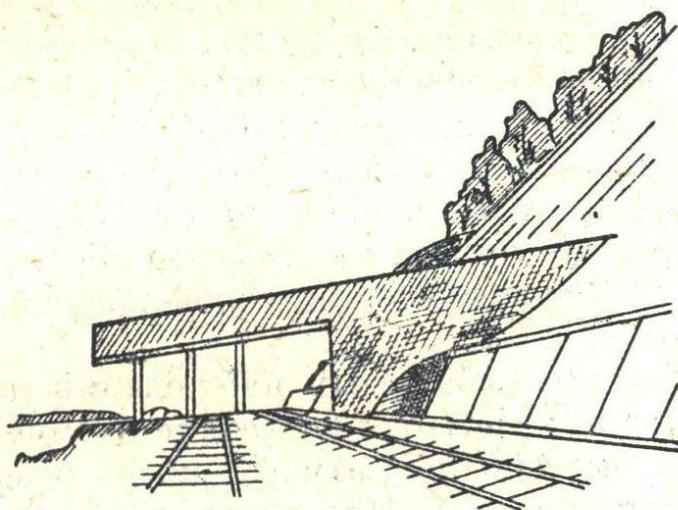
Железобетонный селедук для организованного сброса селя над полотном дороги.
